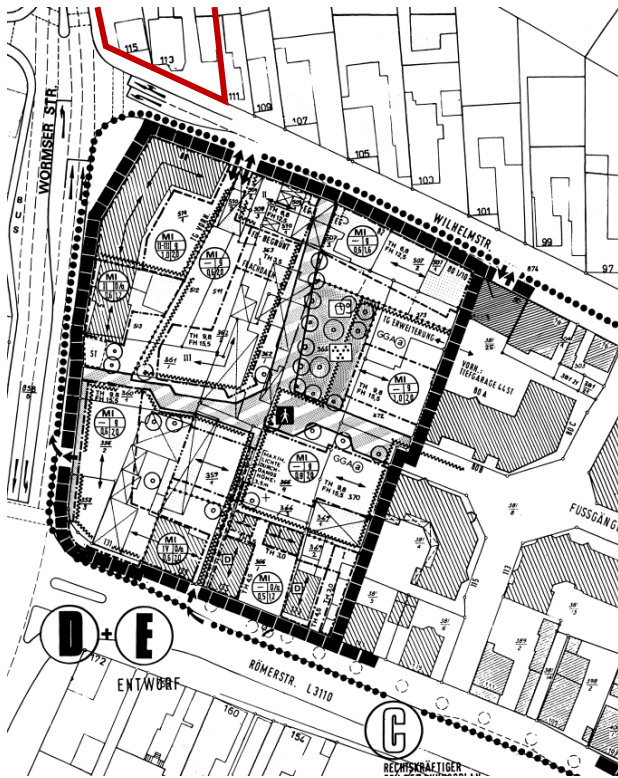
Bebauungsplan „Untere Römerstraße“
